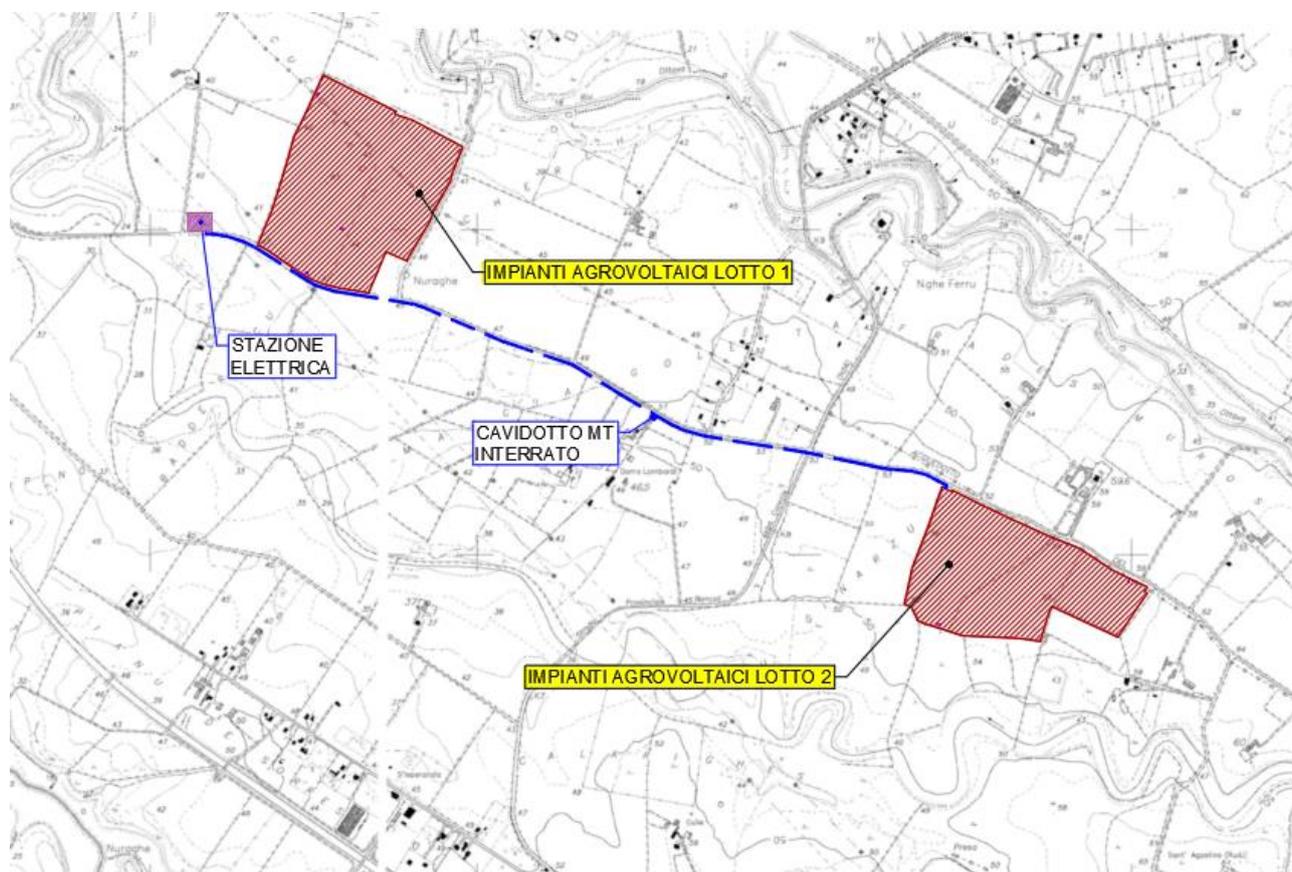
Planimetria cavidotti di connessione lotto 1 e 2
